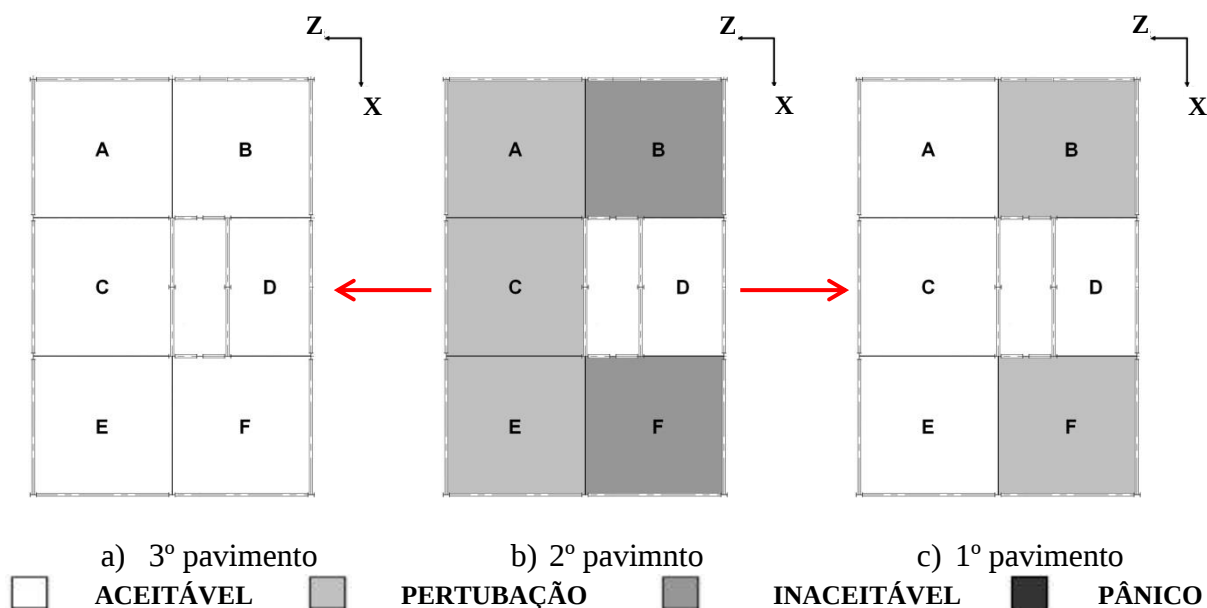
Percepção da vibração no 2º pavimento e pavimentos vizinhos devido ao MC-I: aeróbica
